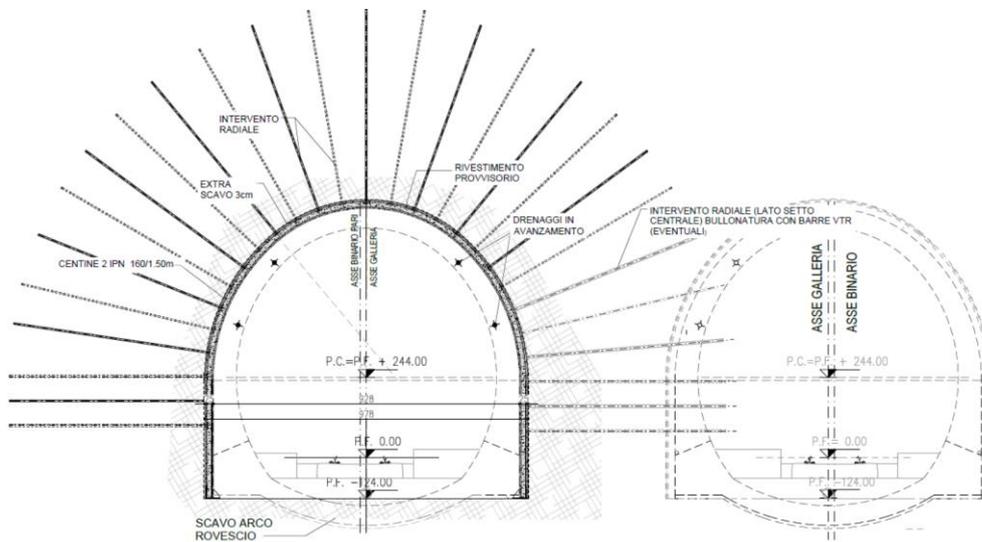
Galleria di linea: Sezione As – Fasi esecutive 1/3.
